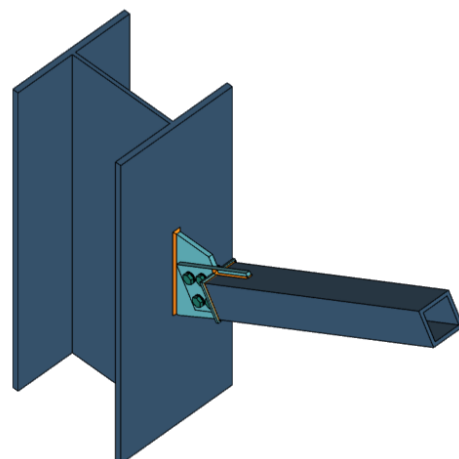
Articulacion poteau-barre de contreventement en tube carré avec montage pénétrant sur gousset
